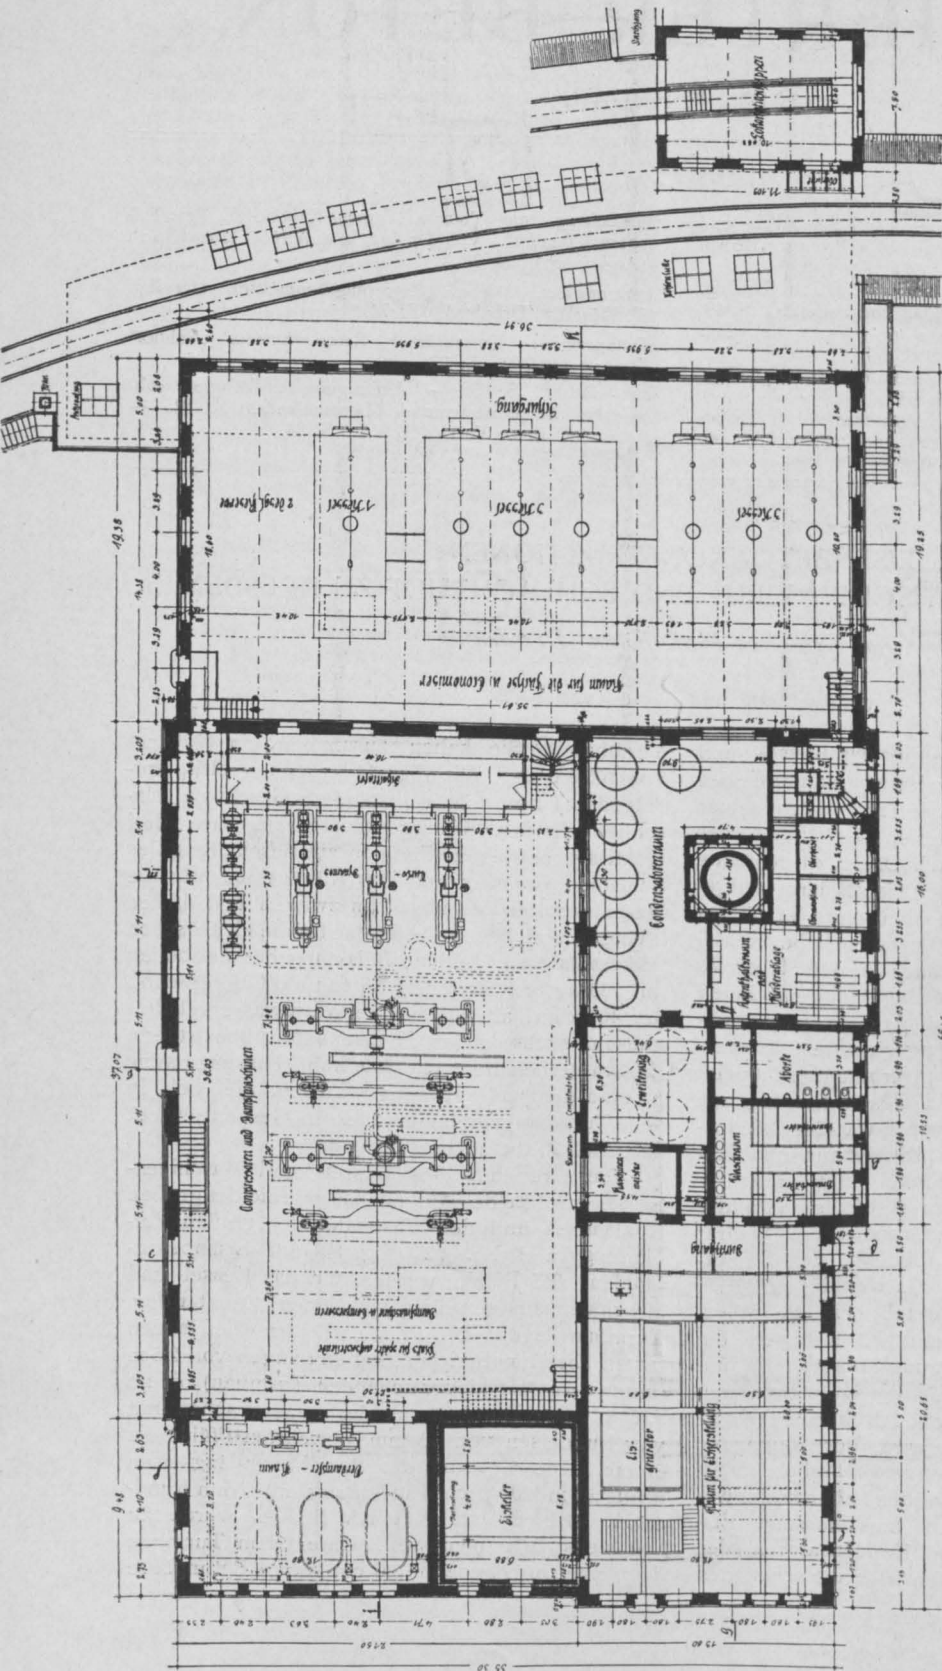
Grundriß vom Kessel- und Maschinenhaus.
